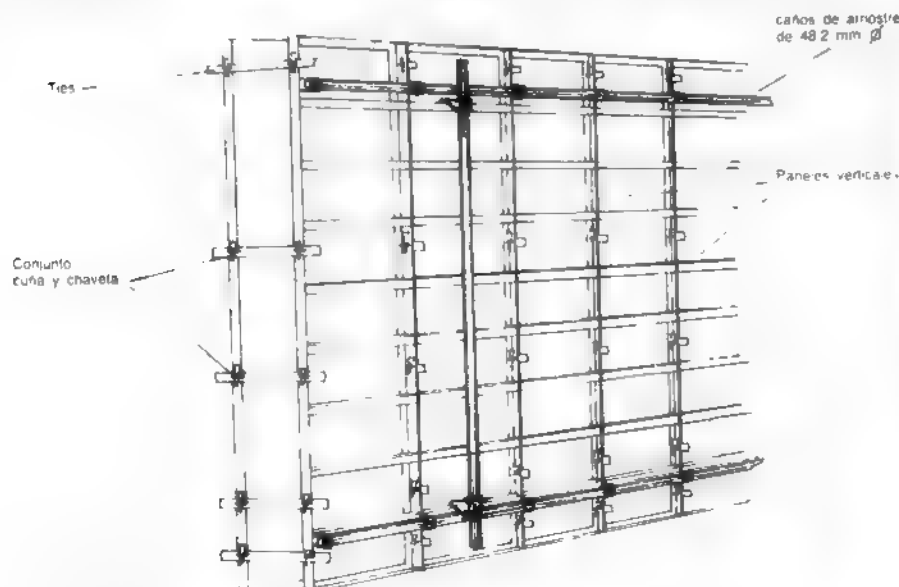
Sistema Acrow New Form. Esquema de armado.
